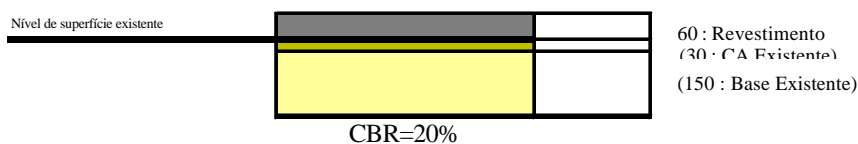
Estruturas de Pavimento Propostas (1)
